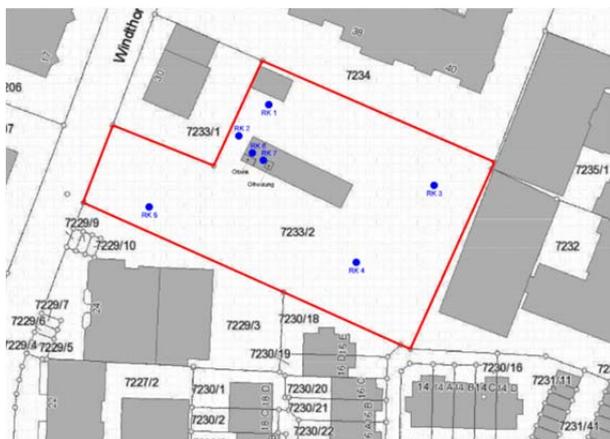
Lageplan Kleinkernbohrungen, hsw, ohne Maßstab
